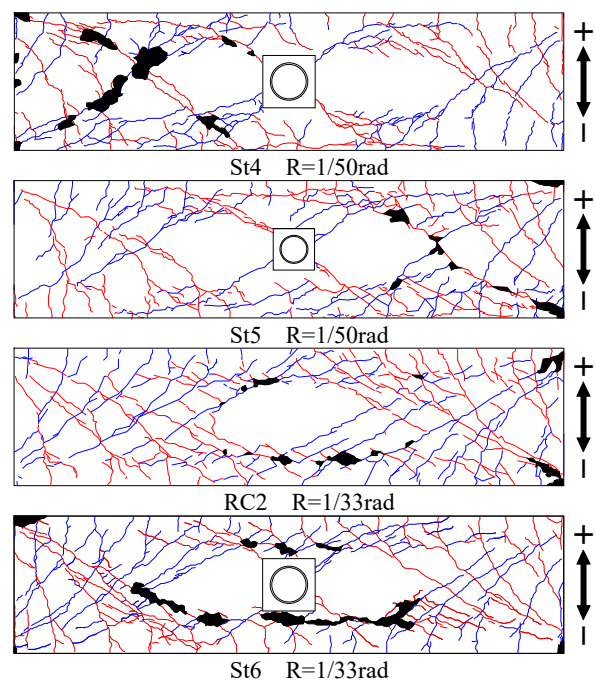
最終ひび割れ状況 (右側が実験時上)
